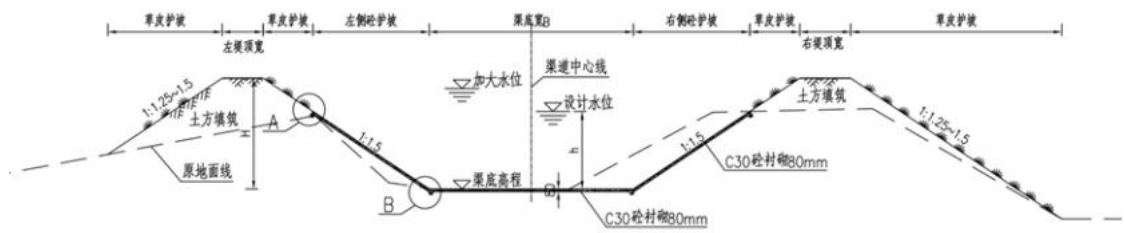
填方渠段混凝土衬砌梯形渠道典型断面图
